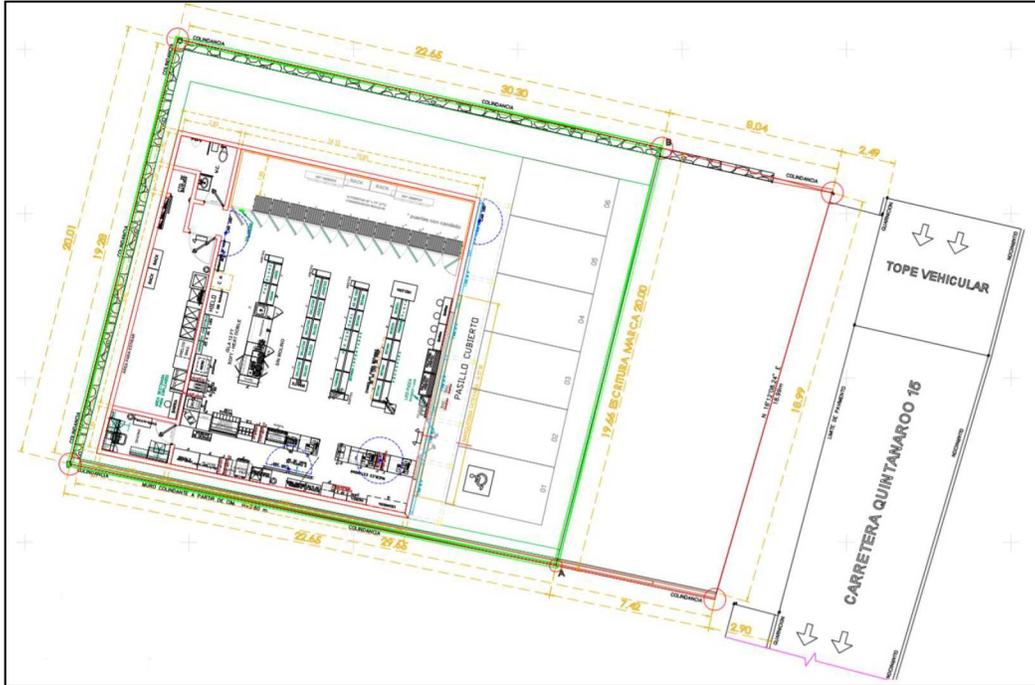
Extracto del plano de conjunto del proyecto, donde se observa la planta arquitectónica
